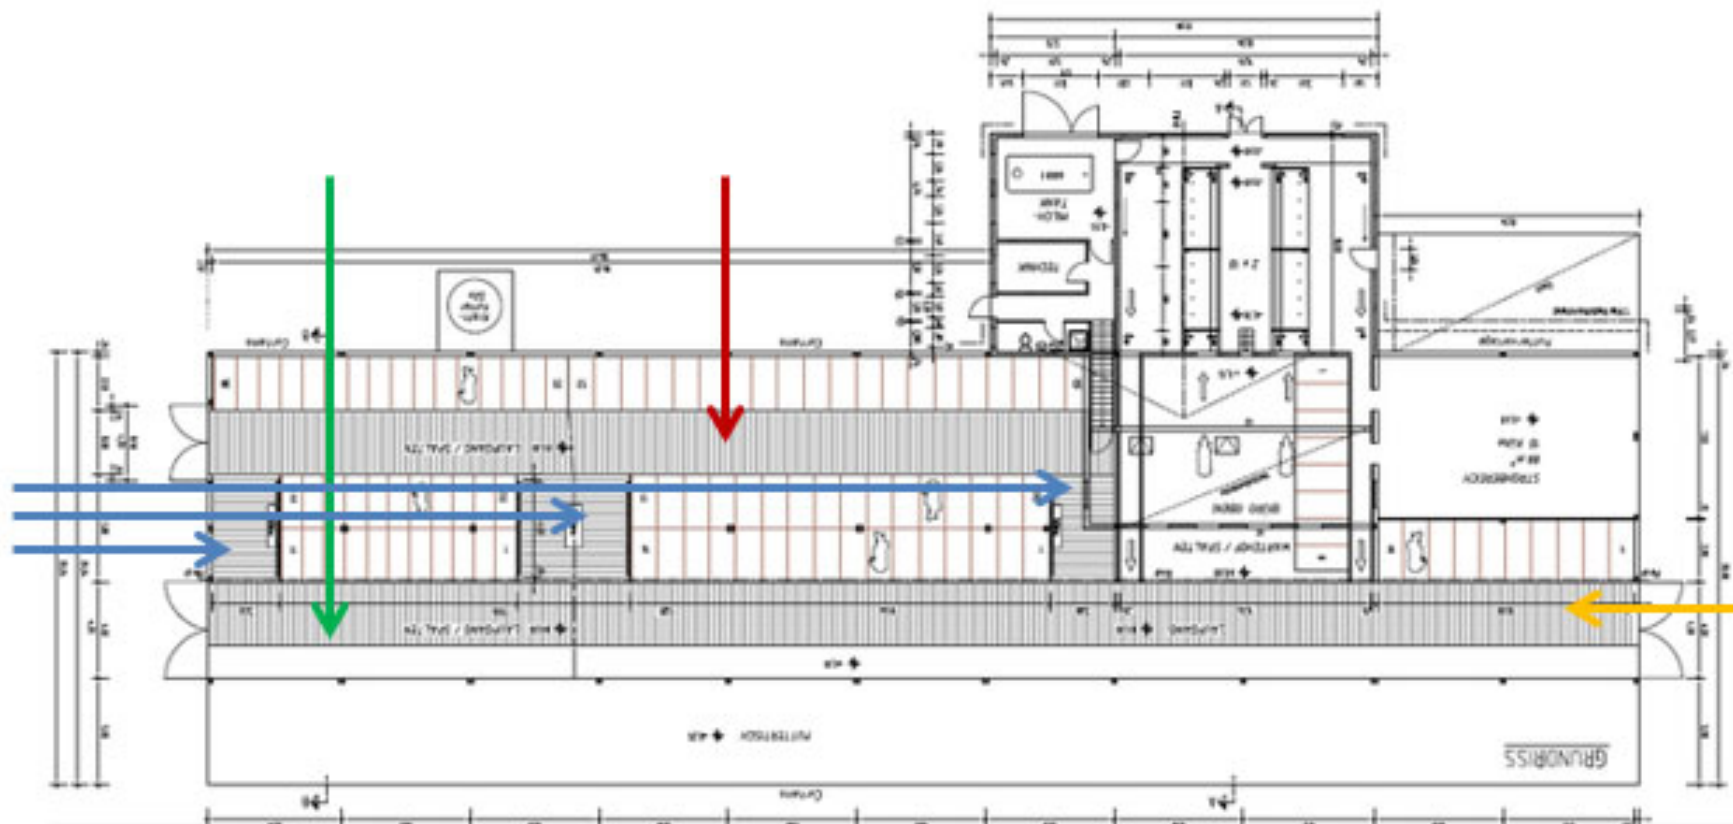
Grundriss Boxenlaufstall.
